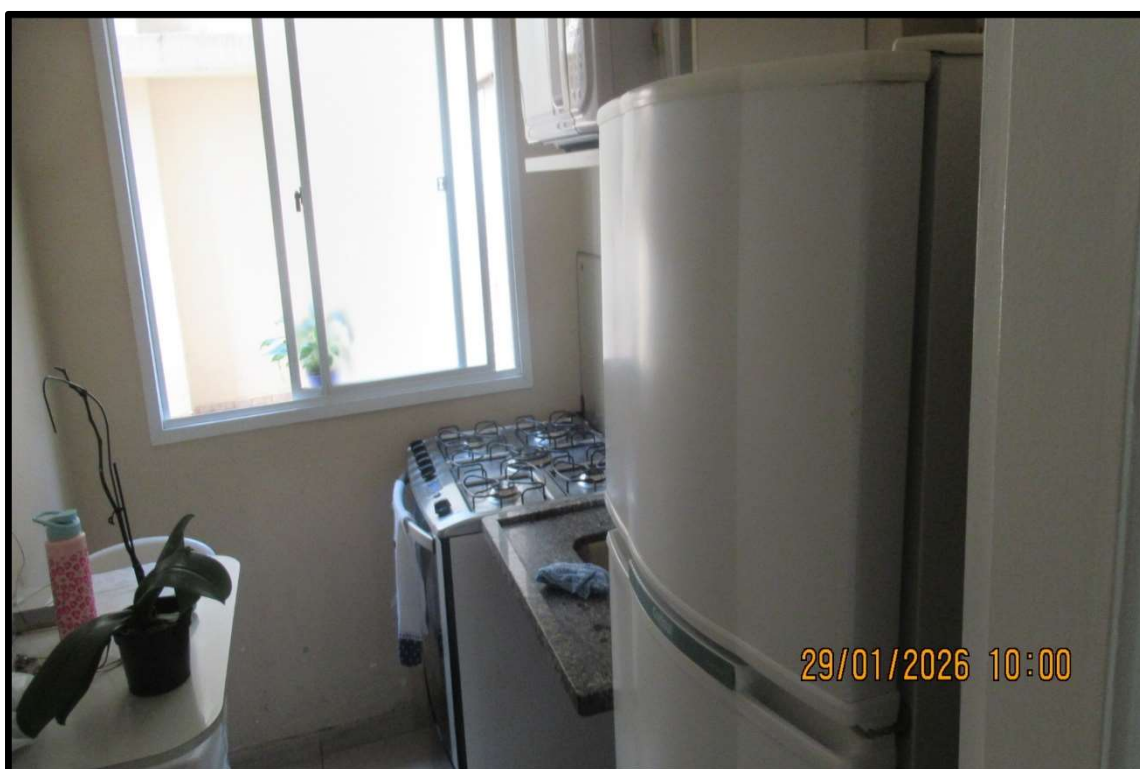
Vista da cozinha existente na área comum do Edifício.
